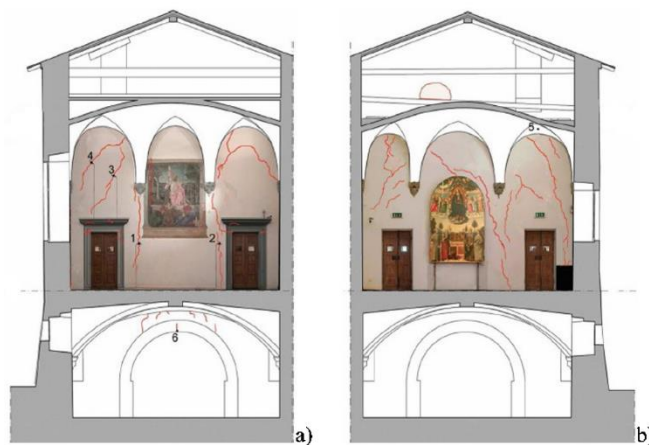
Les fissurations du mur contenant la fresque : (a) vue de face; (B) vue arrière.
